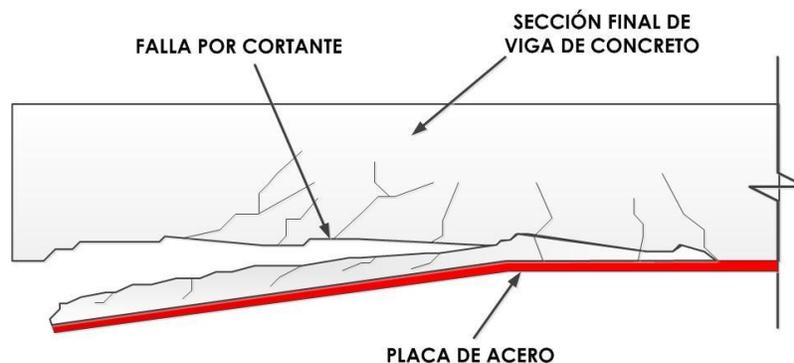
Falla de la placa por desprendimiento en los extremos (Ryall, 2001)
